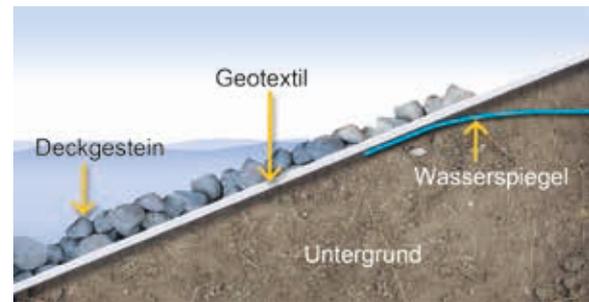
Küstenschutzbauwerk mit Deckgestein und Geotextil
